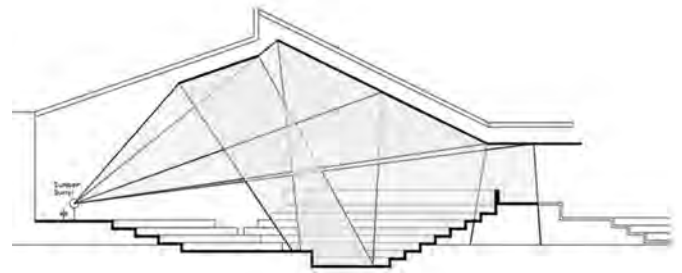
Studi Pemantulan Suara Terhadap Bentuk Denah
